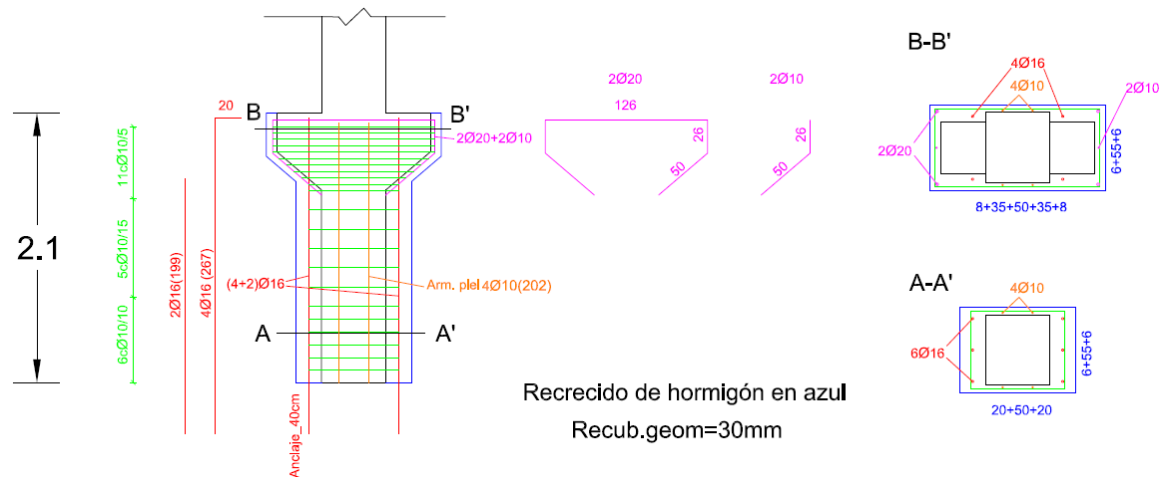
Recreido para pilares en planta inferior. Fuente: Anejo de rehabilitación de estructuras de la Plaza de la Reina [44]
